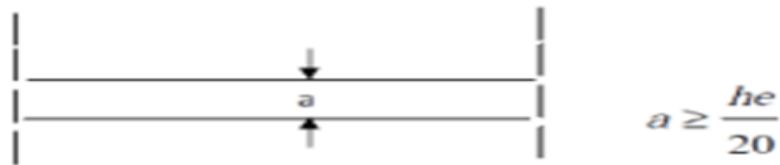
Coupe verticale des types des voiles en plan (RPA 99 /version 2003).
